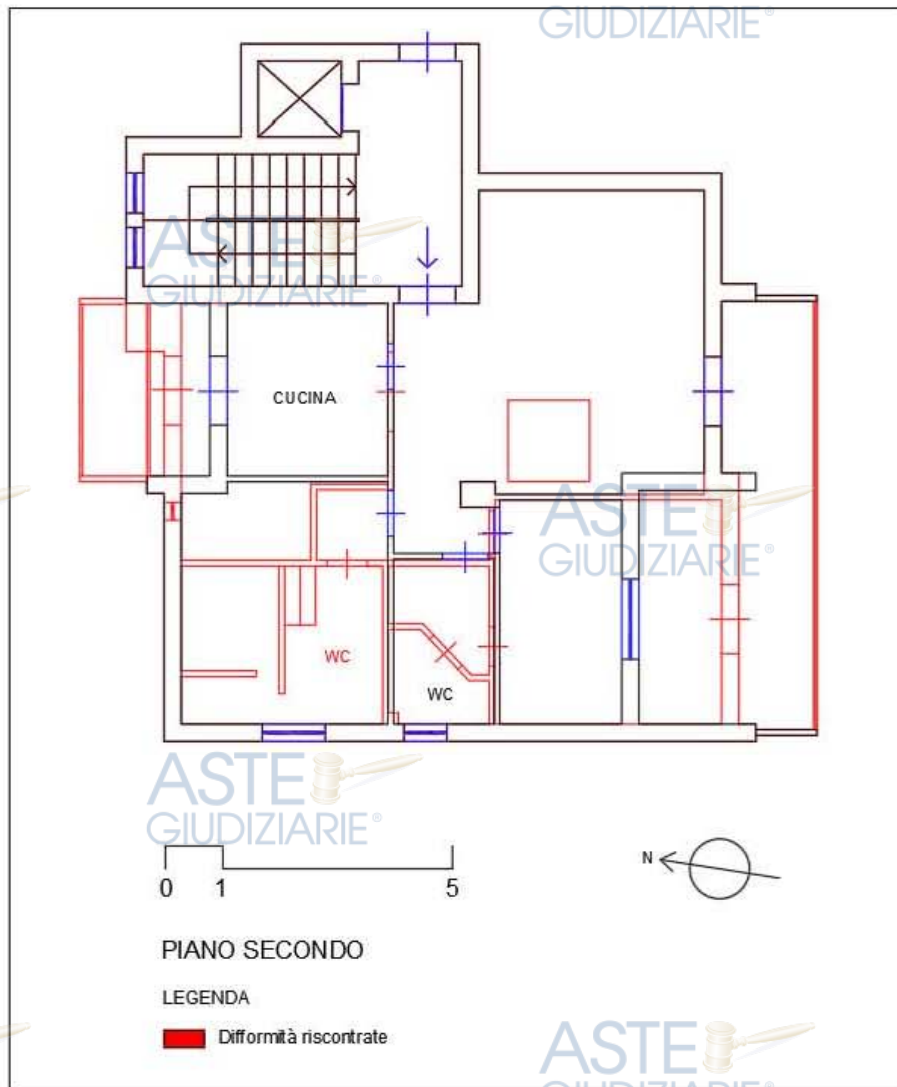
Difformità riscontrate rispetto la planimetria associata alla Concessione in Variante n. 67/2008: piano secondo
